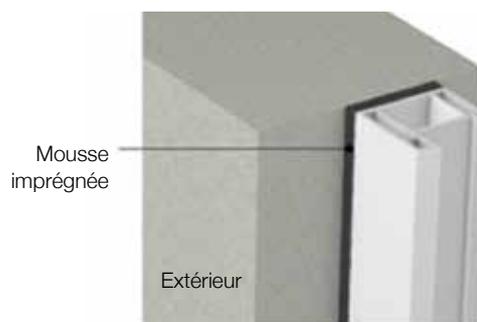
Principe de pose de mousse imprégnée en tunnel
